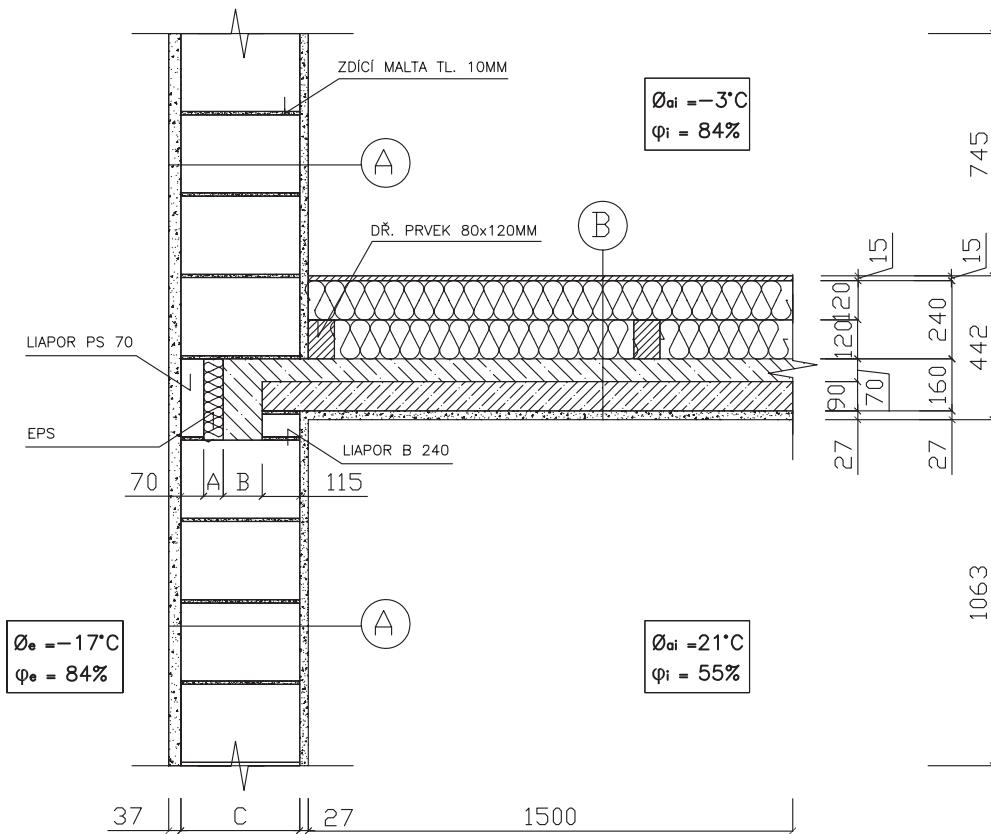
detail ztužujícího věnce mezi nevytápěným podlažím a vytápěným podlažím
